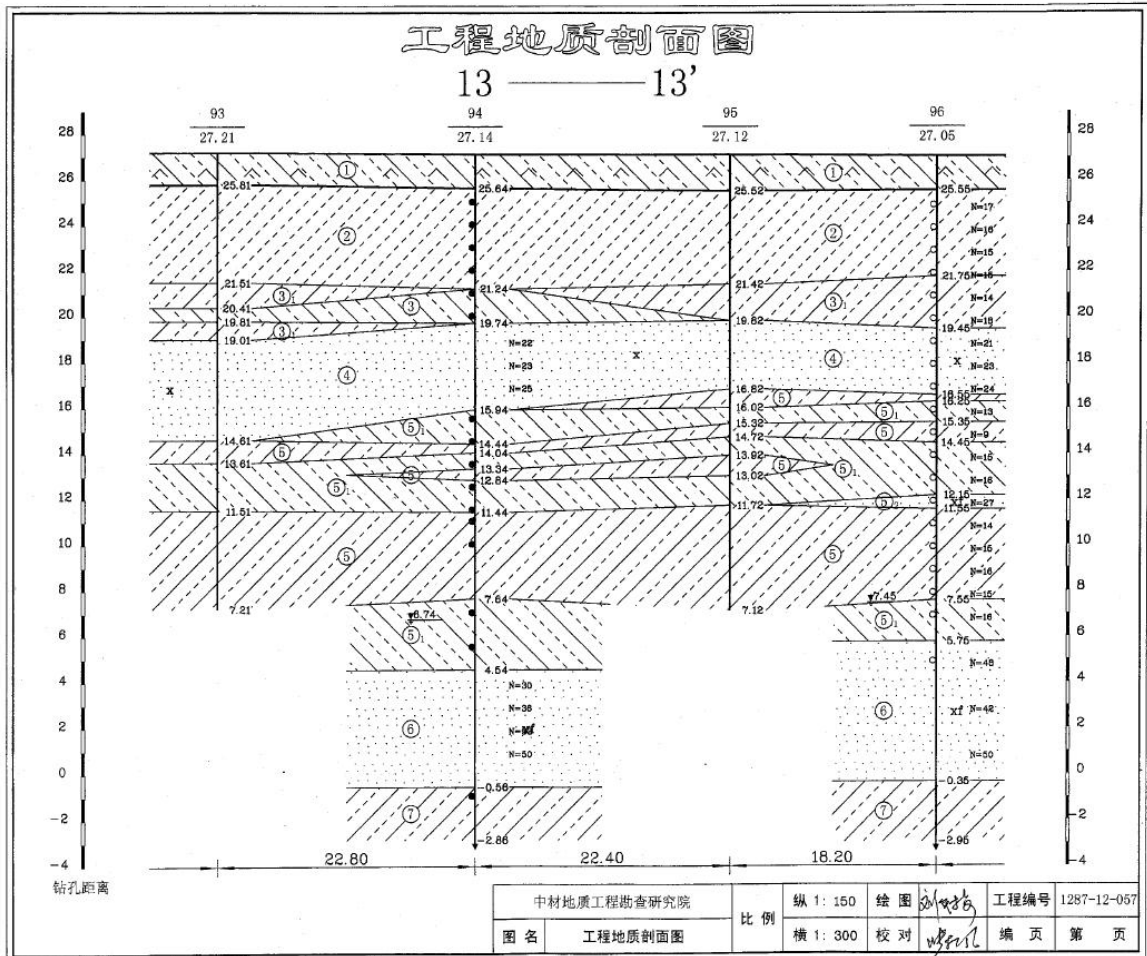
厂区地层钻孔剖面图 13-13'
